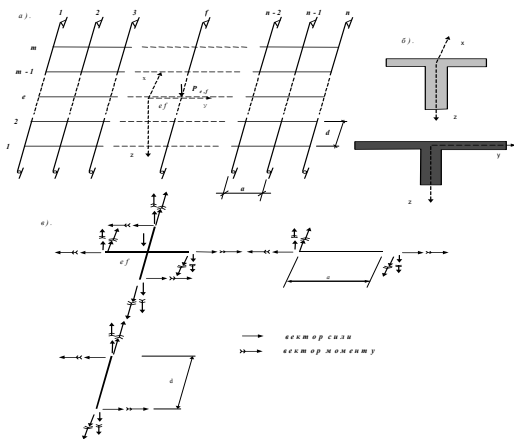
Статична схема перехресно-ребристої системи: а – осі поздовжніх (вісь ОХ) і поперечних (вісь ОУ) балок; б – поперечні перерізи поздовжніх і поперечних балок; в – компоненти внутрішніх зусиль у вузлах і в стрижнях між ними [3]
